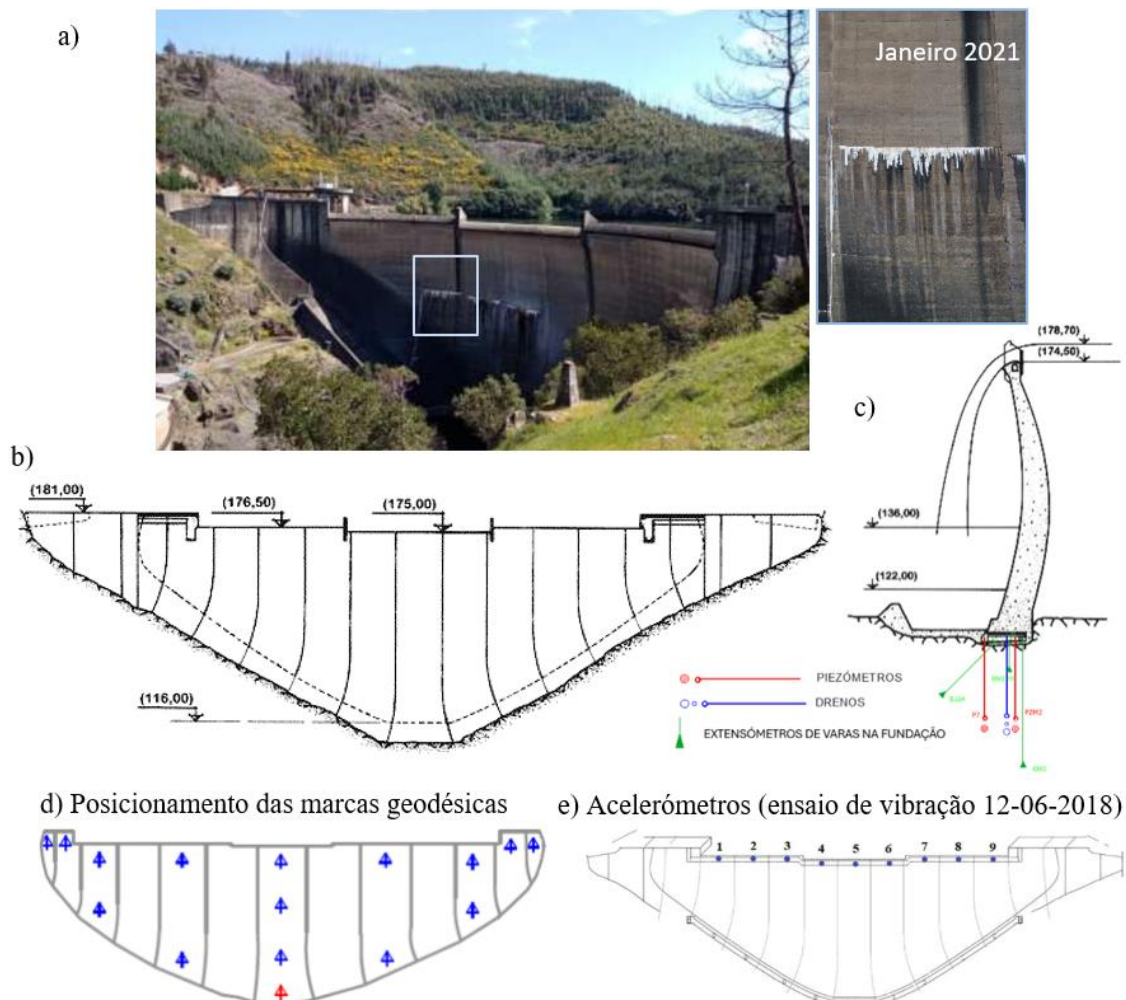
Barragem da Bouçã. a) Vista de jusante onde é salientada a fenda horizontal; Pormenor da fenda em jan.2021 [2]; b) Alçado planificado de jusante c) Corte pela consola central, com indicação de extensómetros de varas na fundação, drenos e piezómetros; d) Marcas geodésicas da rede de triangulação no paramento de jusante; e) Localização dos acelerómetros utilizados no ensaio de vibração ambiente de 12 jun.2018 [7].
